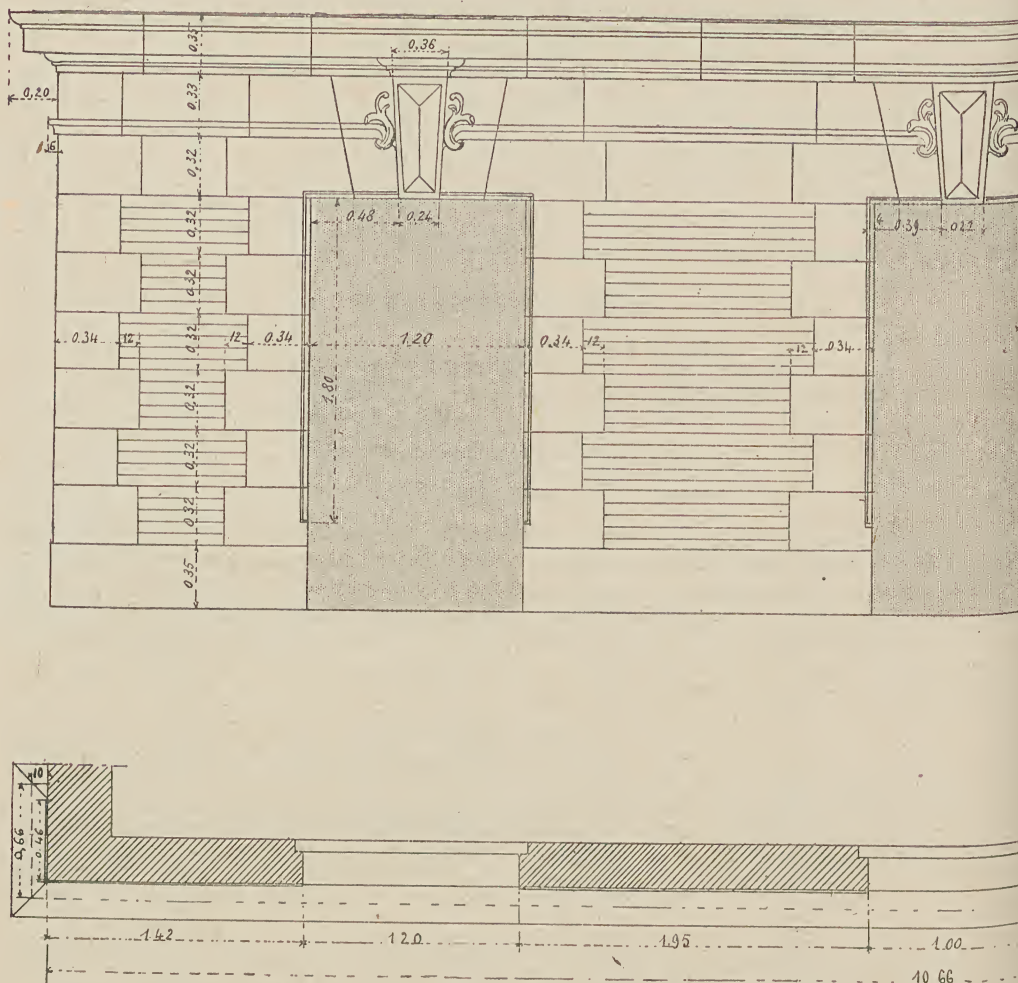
Ravalement sur pierre vieille et sur brique vieille à l'étage d'attique sur rue.
